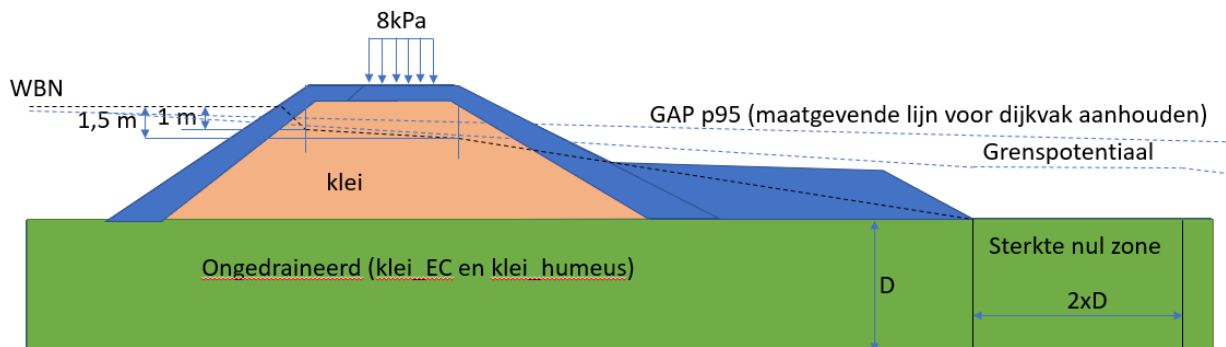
D-Stability – fase 4 (versterkte situatie en WBN) voor dijk met tuimelkade
